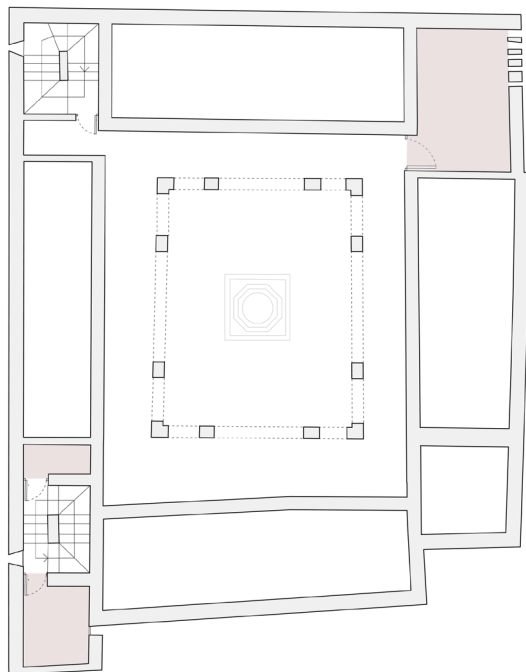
Primera entreplanta de la Casa Demnati. Elaboración propia a partir de la planimetría obtenida en (Revault, Golvin, & Amahan, 1985)
